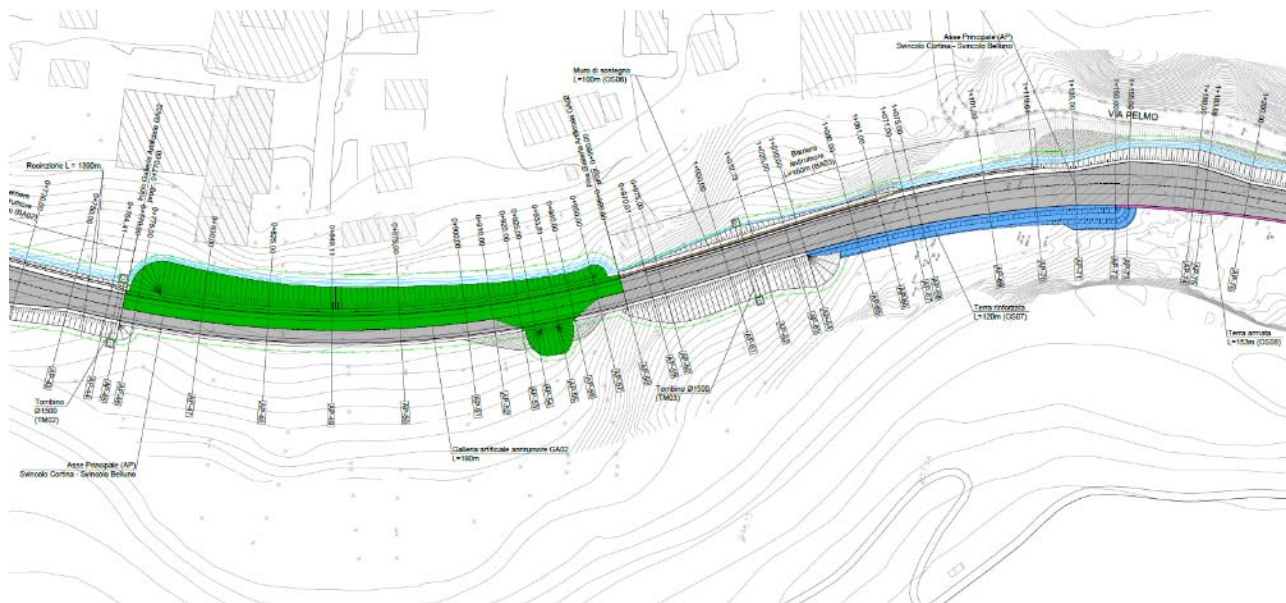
Stralcio planimetrico zona GA02 e terre rinforzate/armate
